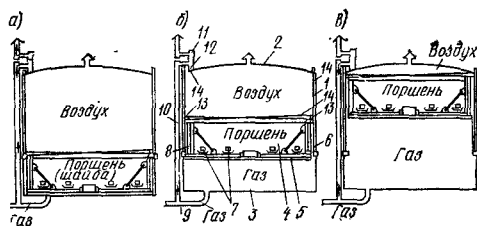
Схема сухого газгольдера с гибкой связью поршня с корпусом
